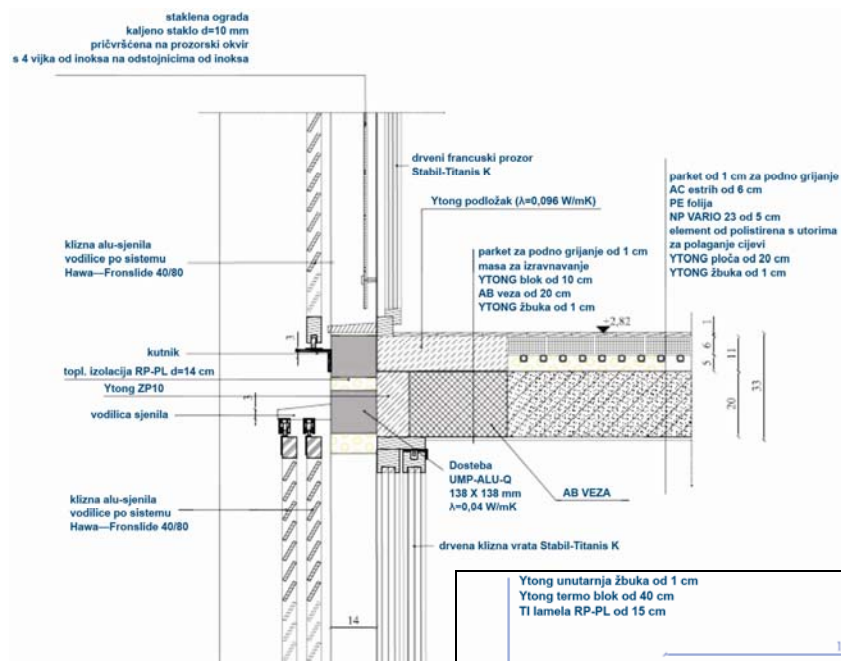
Detalj spoja međukatne konstrukcije s vanjskim zidom
